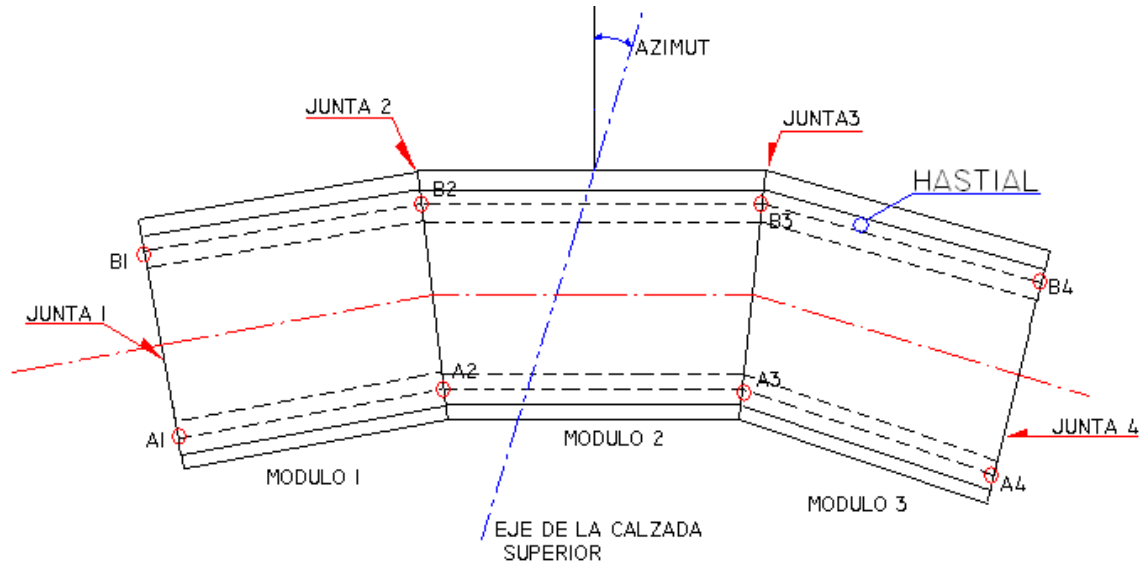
Definición en planta y alzado del módulo de generación automática.
